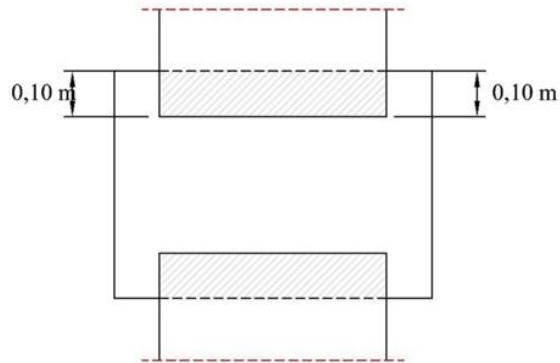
Soudure à plat du 1er joint linéaire en attente
